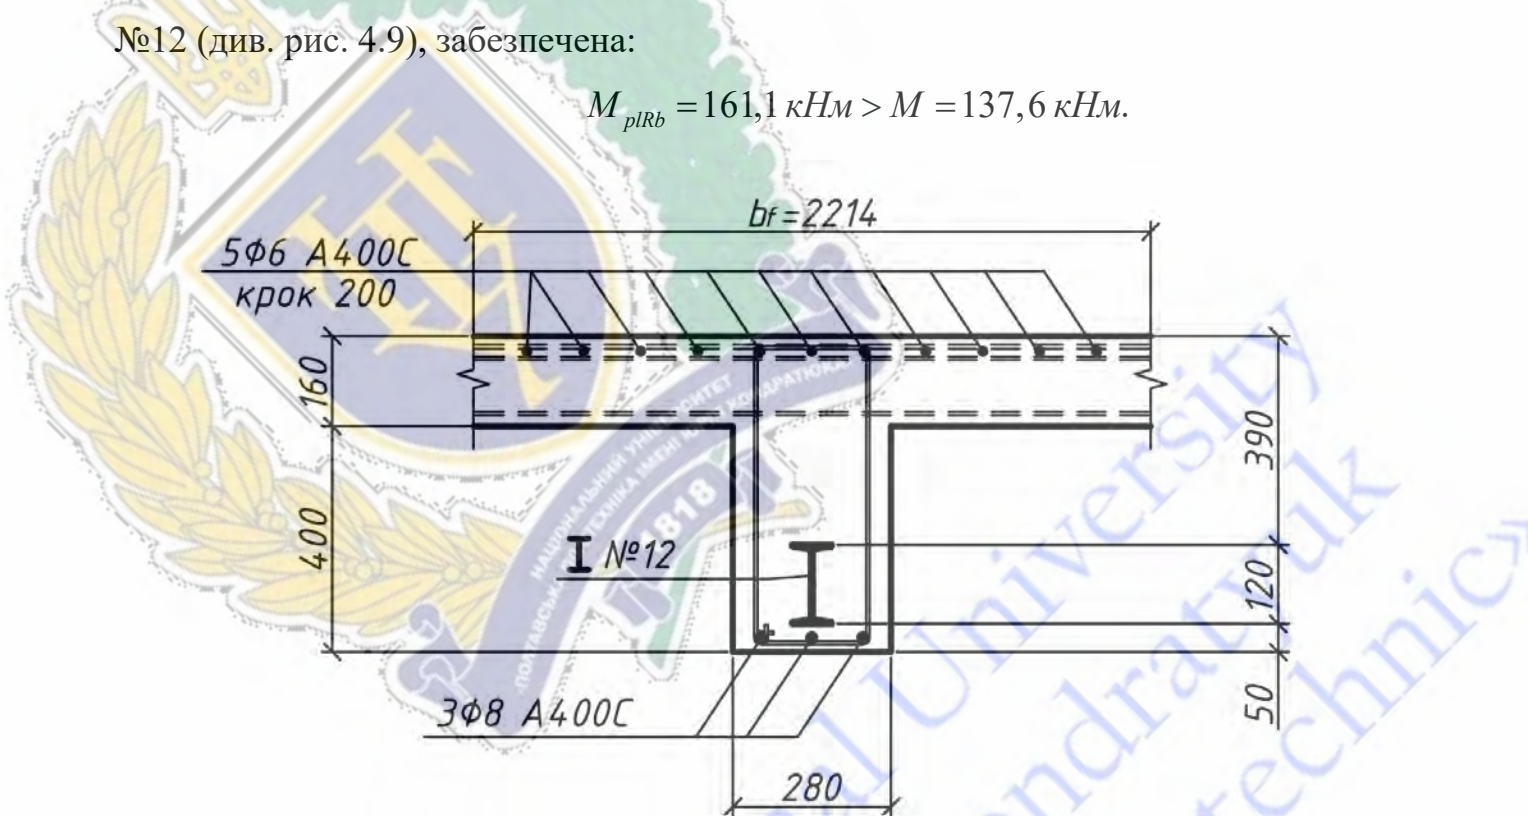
Конструктивне рішення перерізу сталезалізобетонного балкового елемента міжповерхового перекриття будівлі, який армований сталевим профілем із прокатного двутавра №12.
